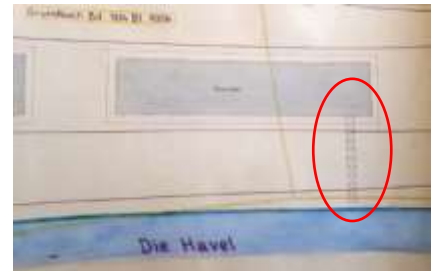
Detail Lageplan 1948. Statisches Gerüst an Speicher 2.
